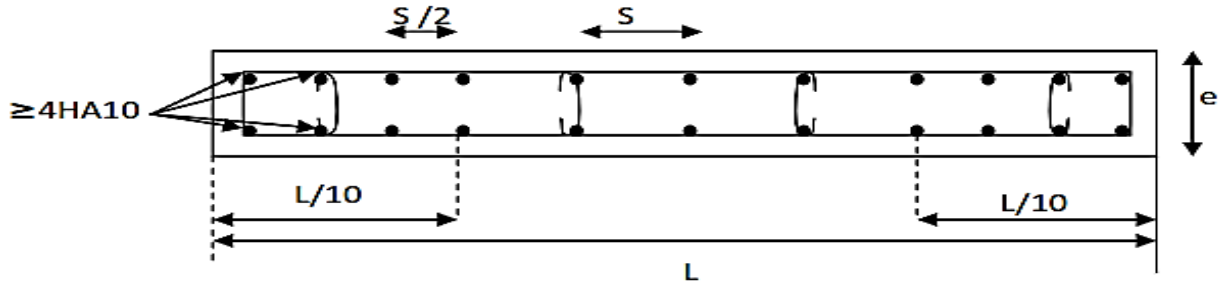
Disposition des armatures verticales dans les voiles.
